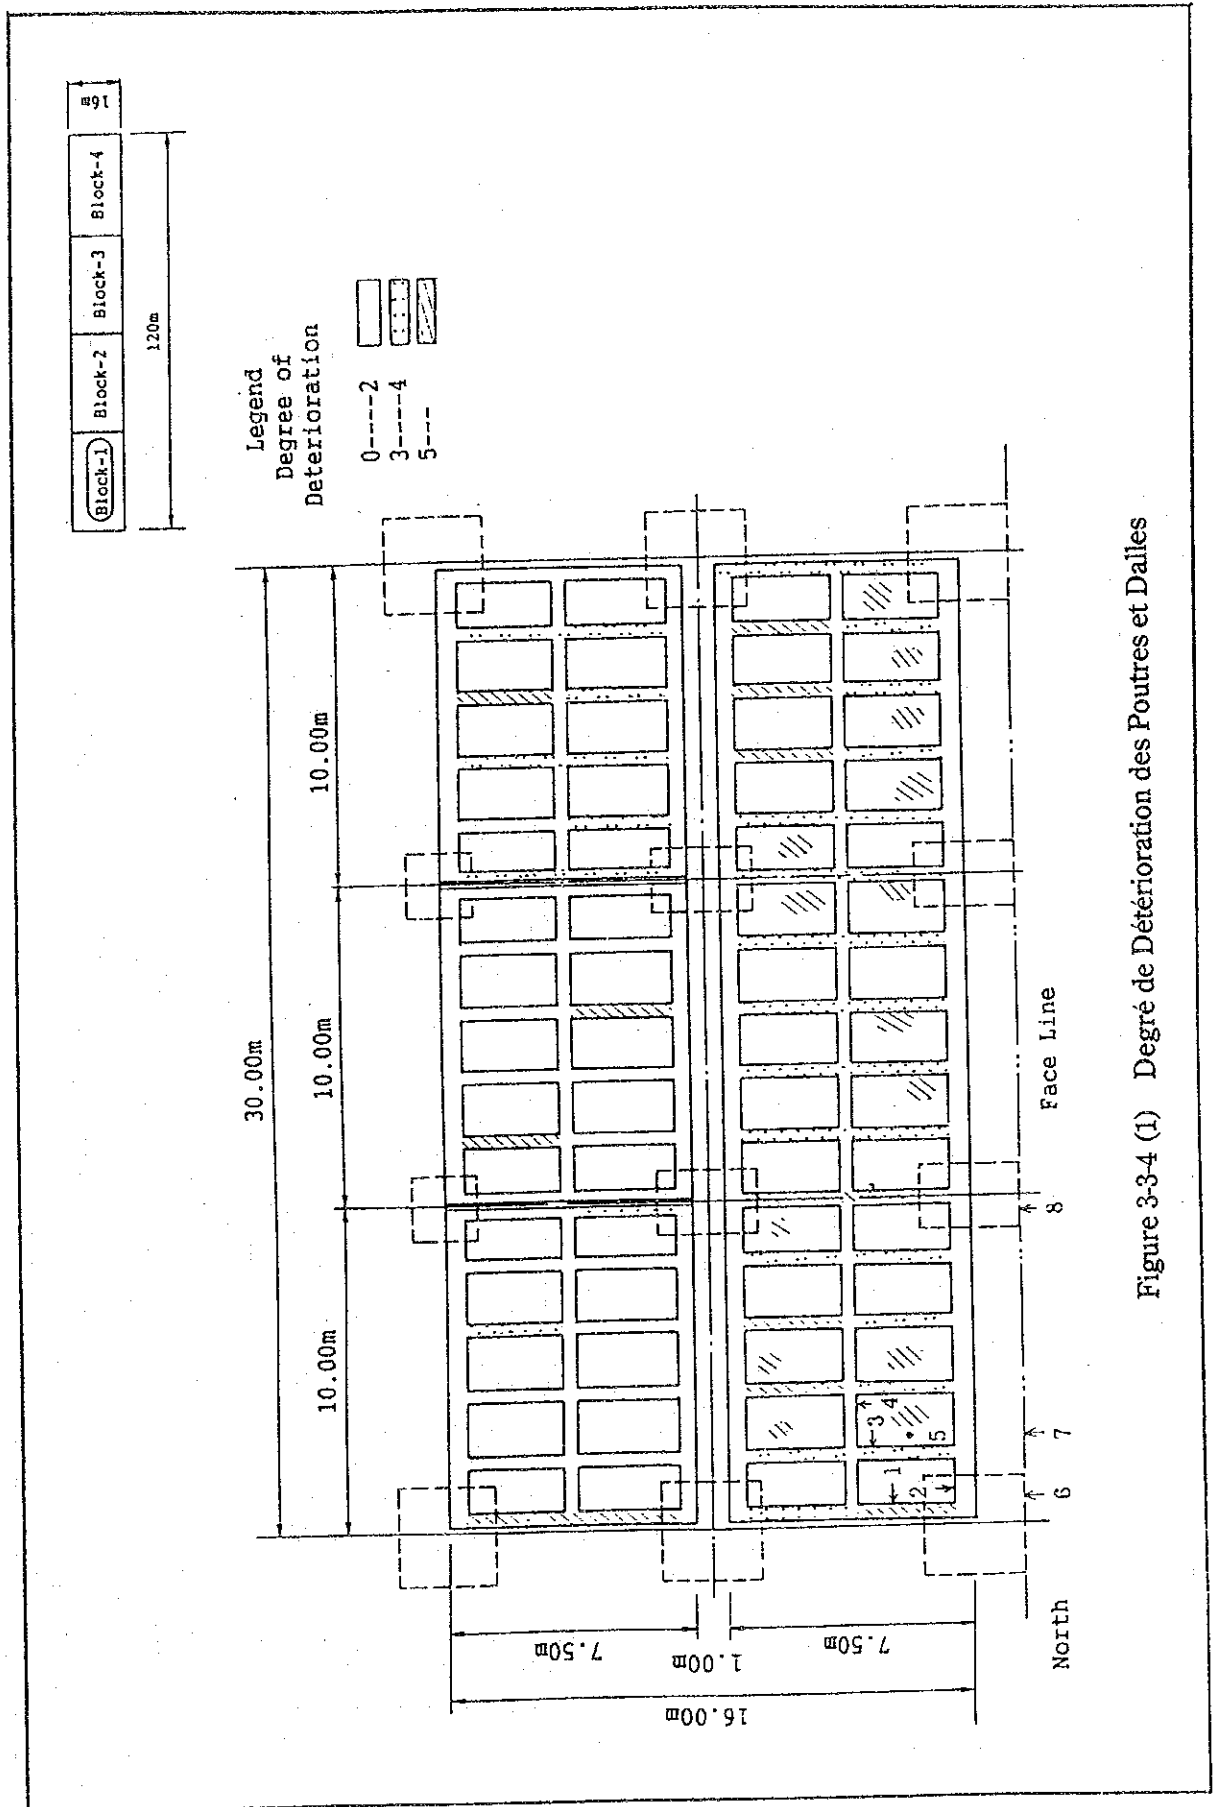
(1) Degré de Détérioration des Poutres et Dalles
